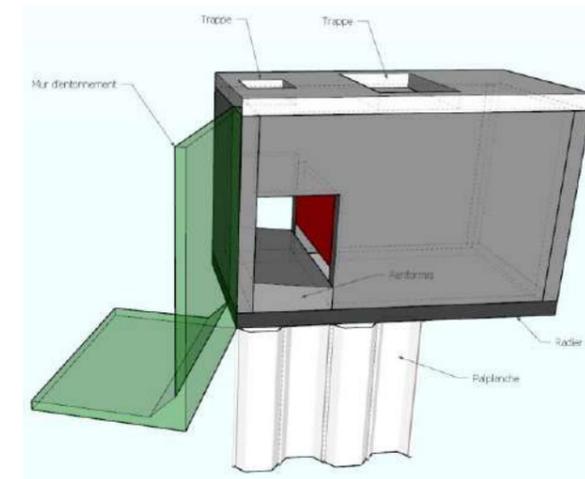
Vue 3D du caisson avec représentation partielle des murs d'entonnement et des fondations palplanches
